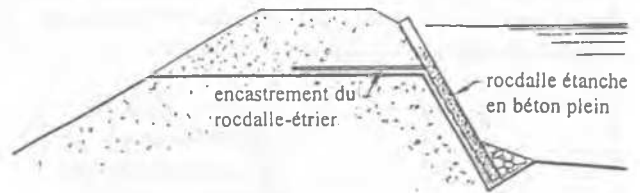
Structure rocdalle béton plein étanche - Coupe type
